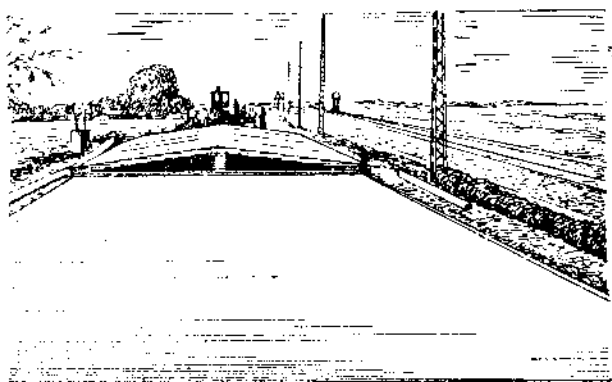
Защита свежеработанной бетонной одежды от дождя и солнца передвижной крышей.
